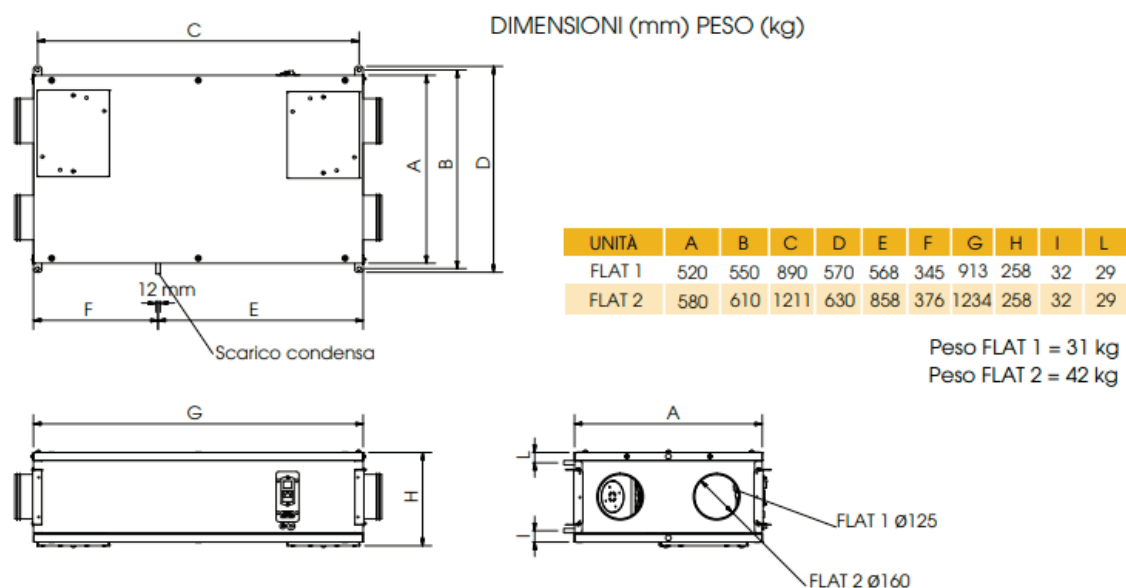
Schema dimensionale unità di ventilazione meccanica Utek Modello Flat [32]
